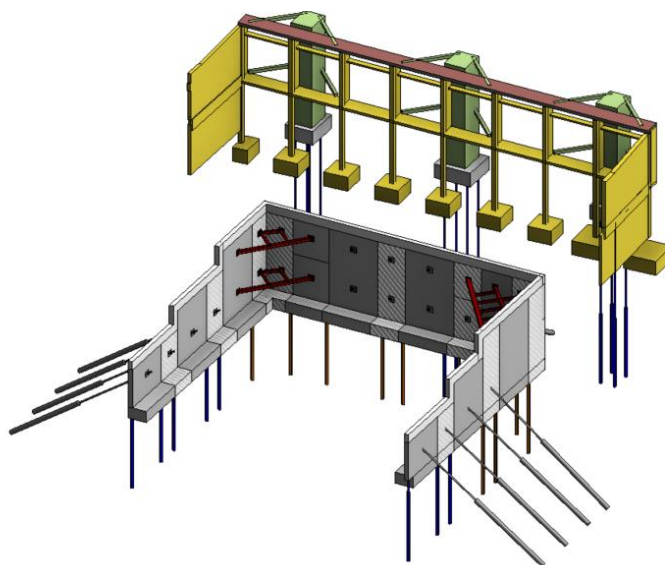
Vista do modelo BIM de escavação de contenção periférica e contenção de fachada
